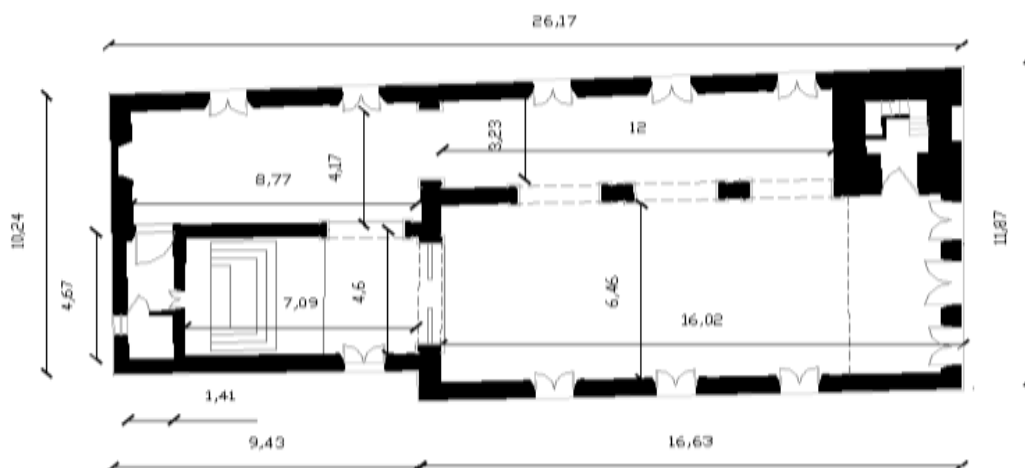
Planta Baixa da Igreja de Nossa Senhora das Dores
